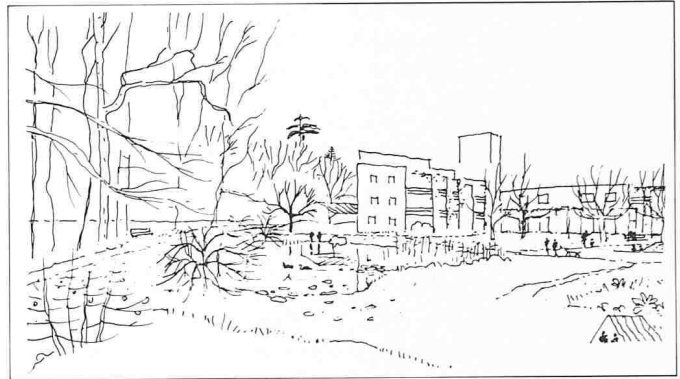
Perspektive Siedlungsaussenraum/Gestaltungsrichtplan (Standort 5 in Bild 2)
